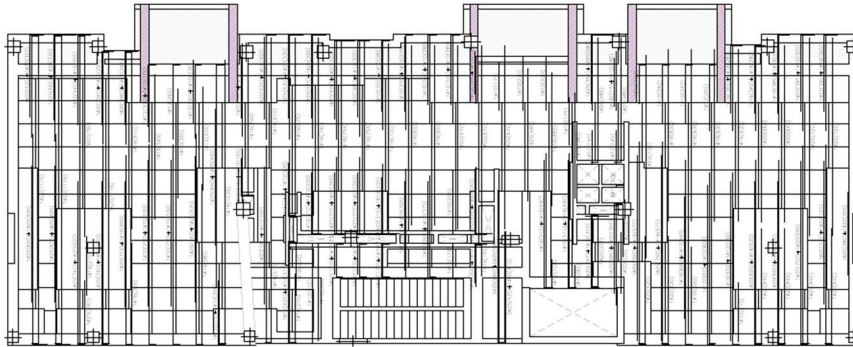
Planta tipo del proyecto de referencia, plantas 2 a 8
